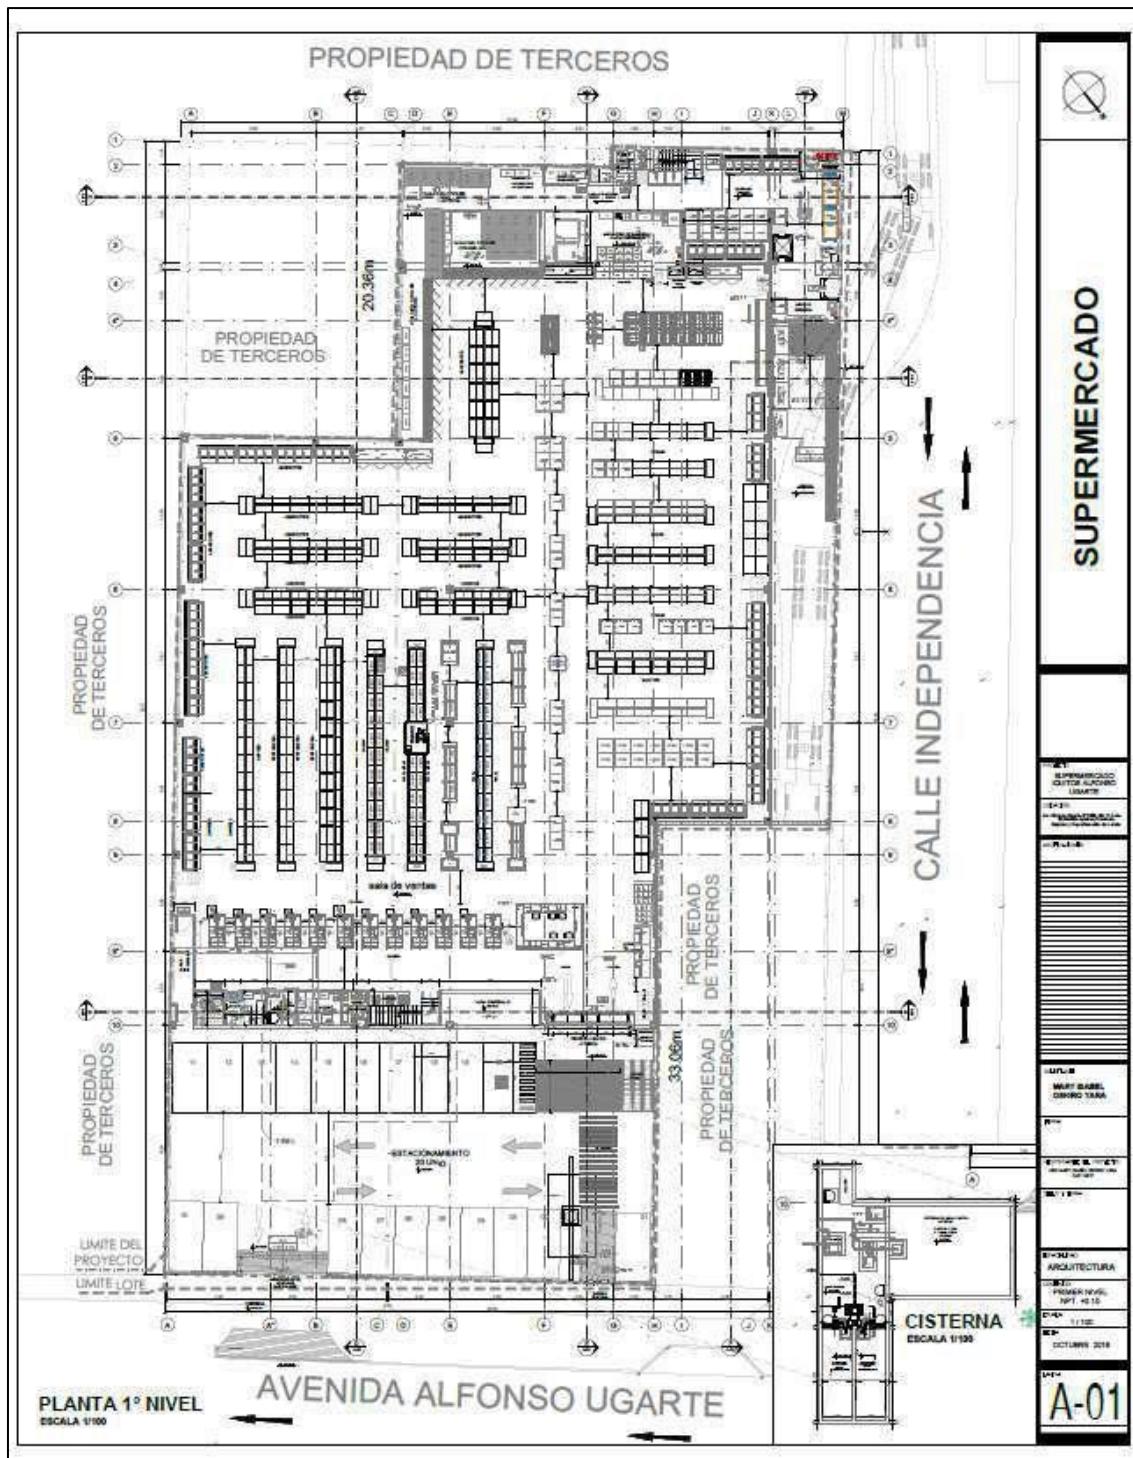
Plano de Planta Primer Nivel - octubre 2018
